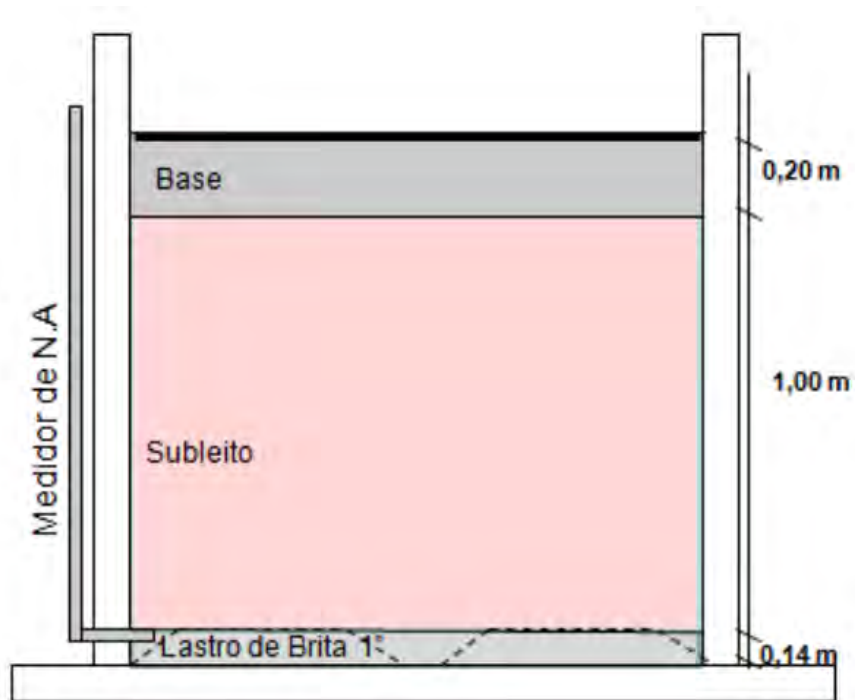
Seção da estrutura de pavimento estudado por Miranda (MIRANDA, 2013)
